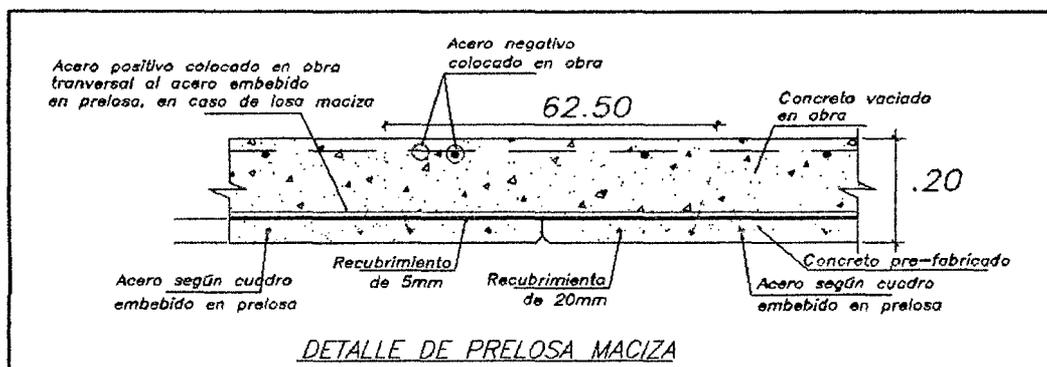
22: Detalle de losa maciza con el uso de prelosa
